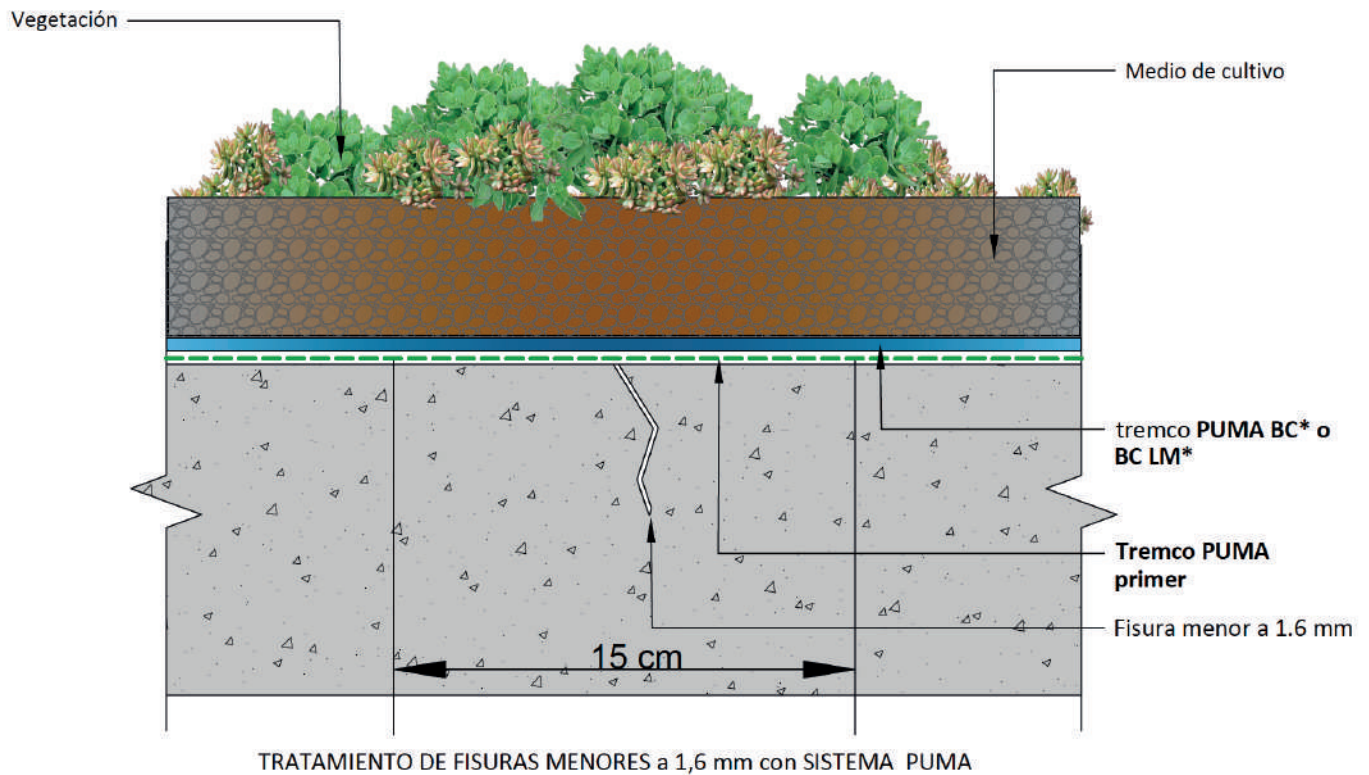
Tratamiento de fisuras menores a 1.6 mm con el sistema TREMproof® PUMA.
